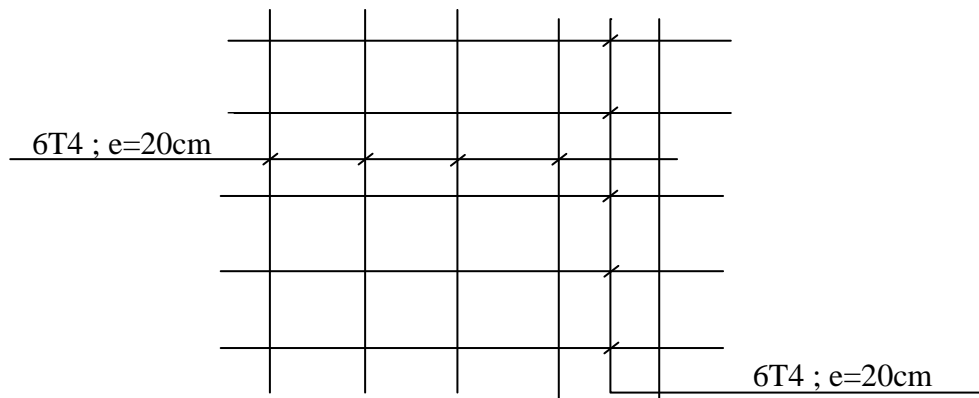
schéma de ferrailage de la dalle de compression.
